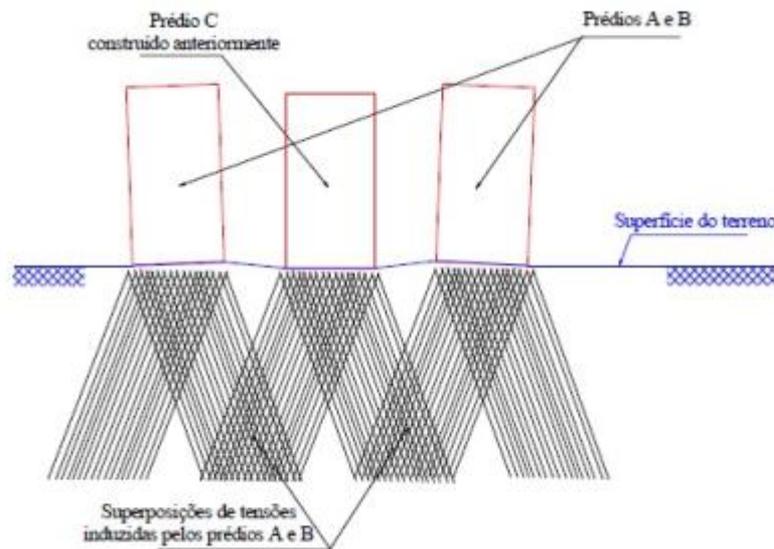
Efeito de construções vizinhas – novo prédio construído entre outros já existentes
